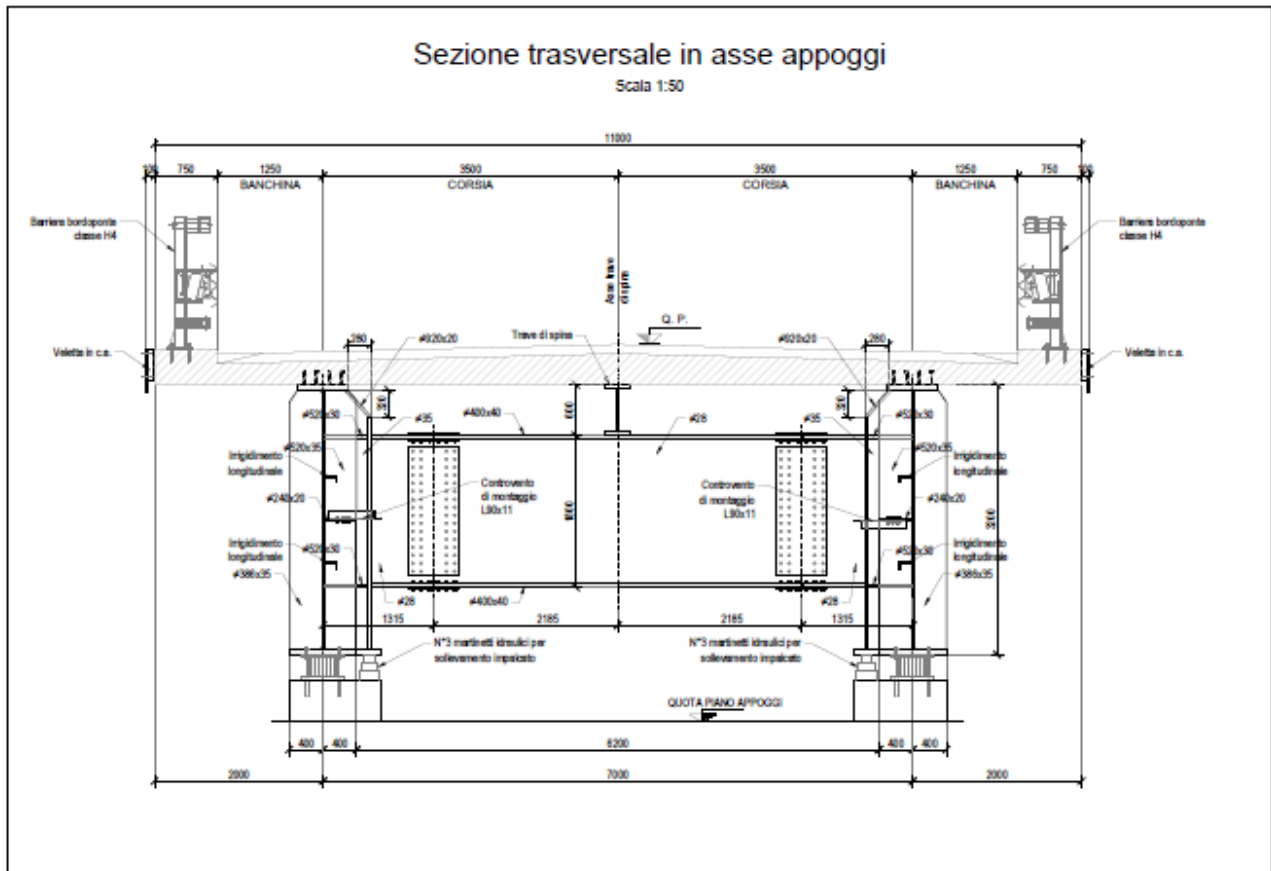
Sezione tipo impalcato su spalla
